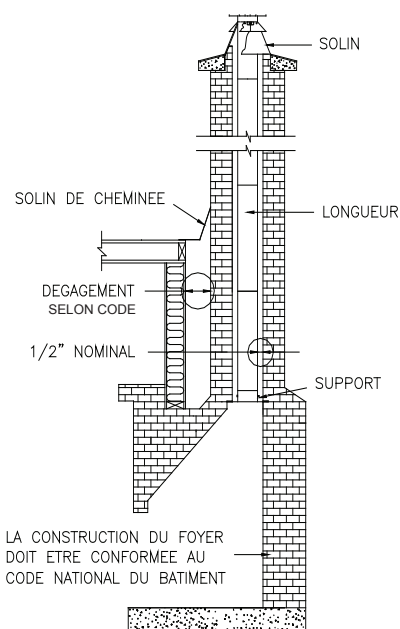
Installation d'un conduit de tubage dans un nouveau foyer
